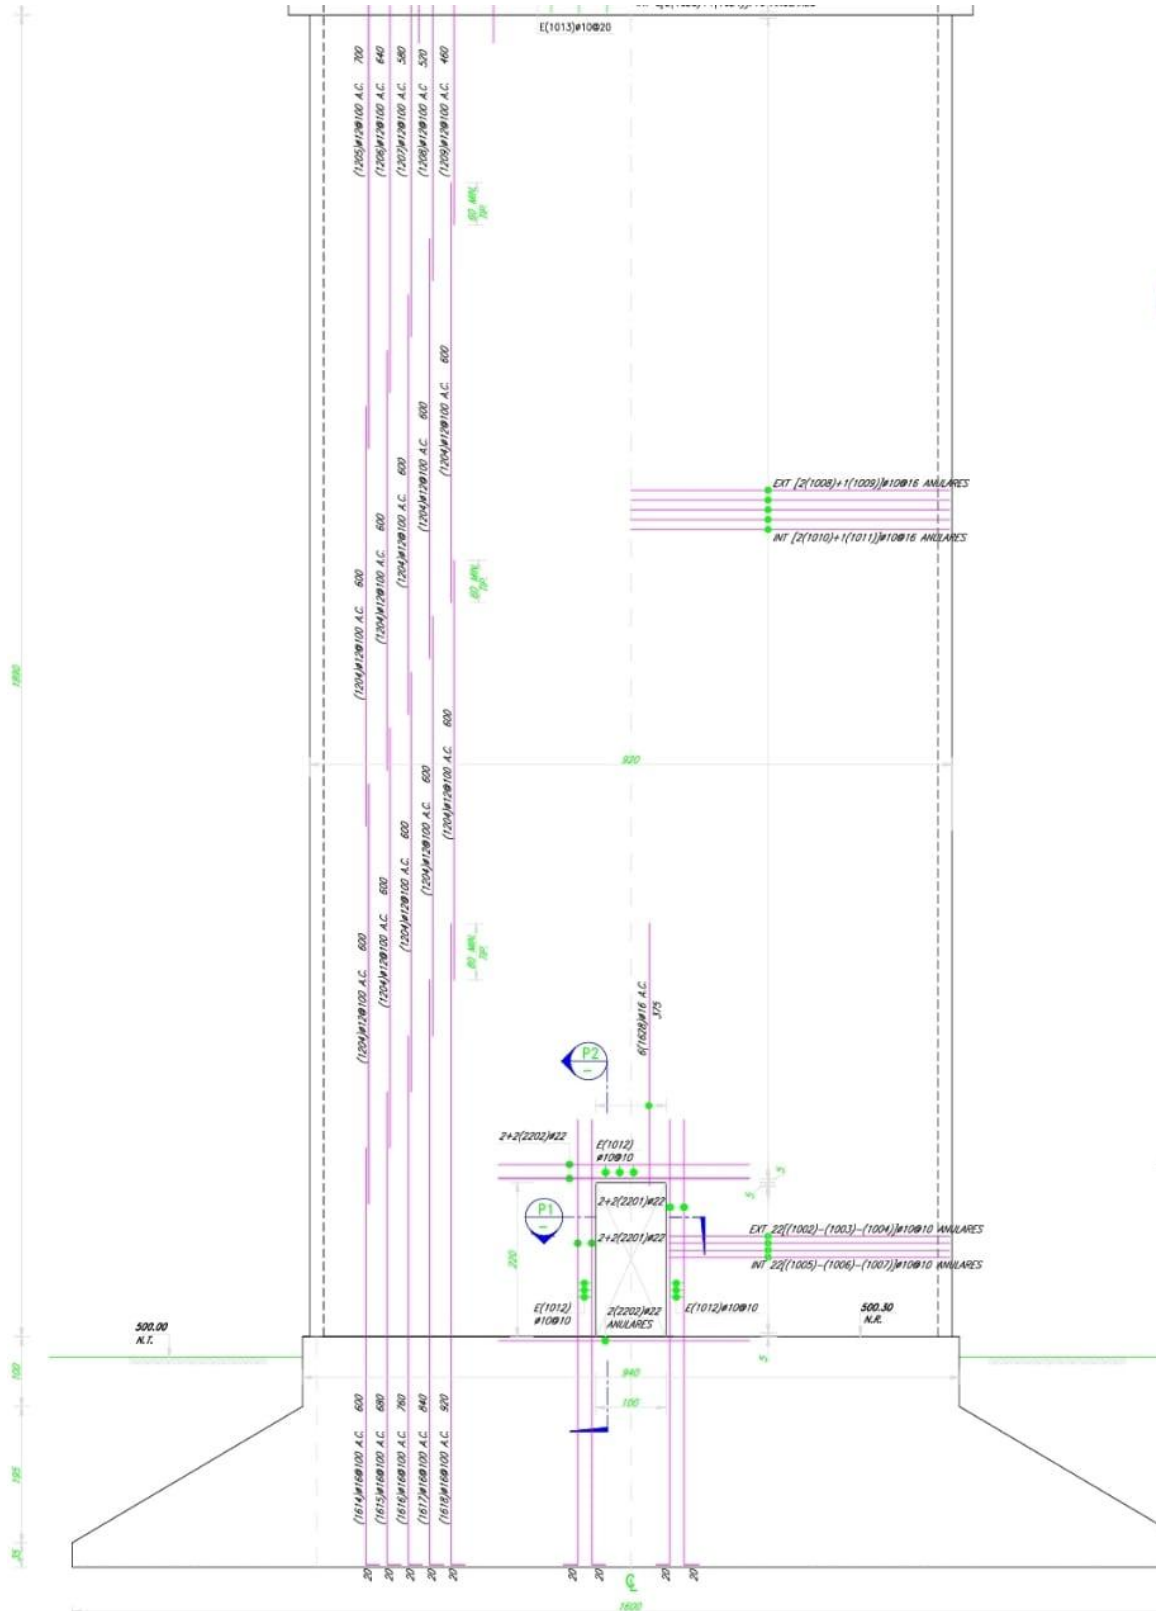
Plano de refuerzos de pedestal estanque Cartagena. Fuente: Plano de diseño proyecto estructural Gilberto Leiva H.
